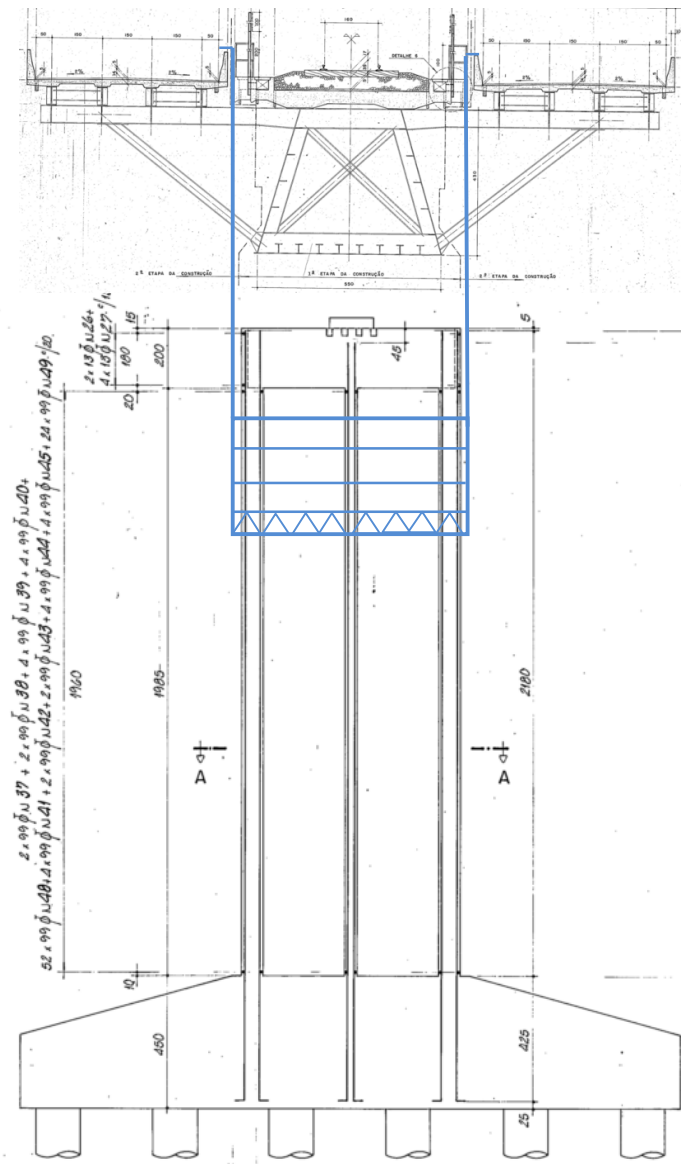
corte transversal da estrutura da ponte com indicação da área da superestrutura ferroviária a ser reforçada nos apoios (pilares)
